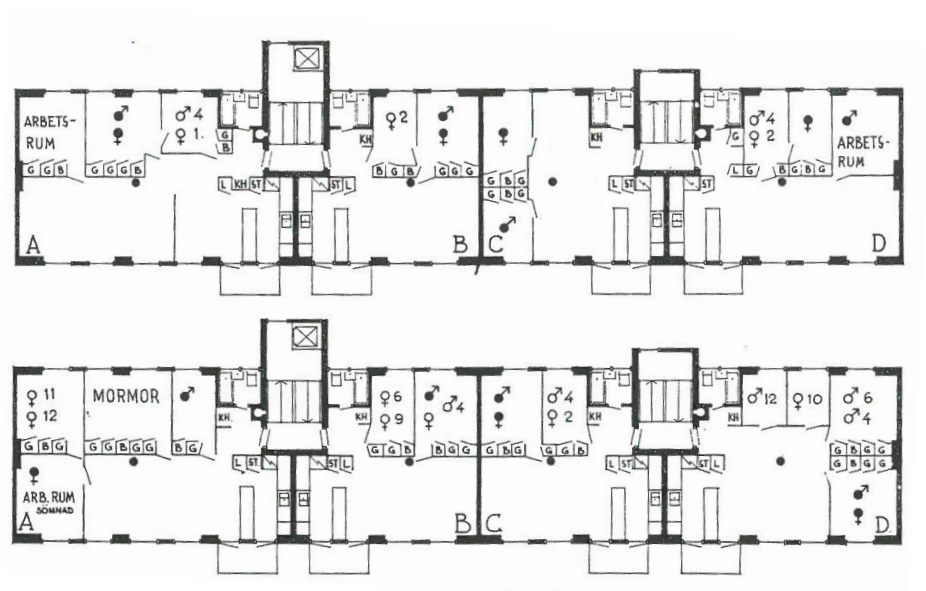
planer experimenthuset med de olika boendenas placering av väggelement.
